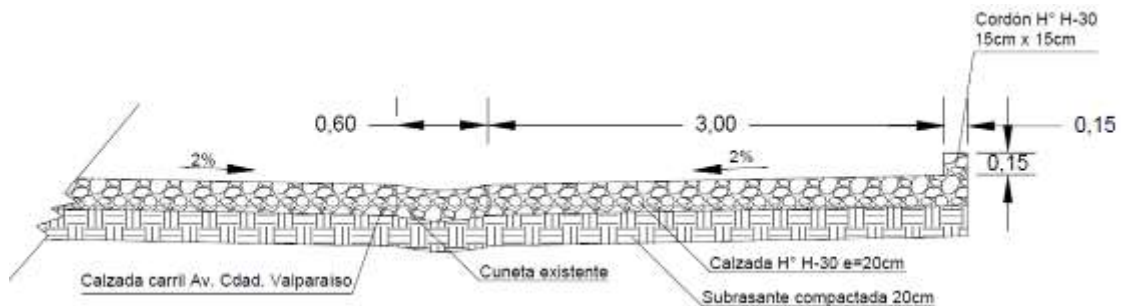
Perfil Tipo Dársena de Desaceleración. Fuente: Elaboración propia
